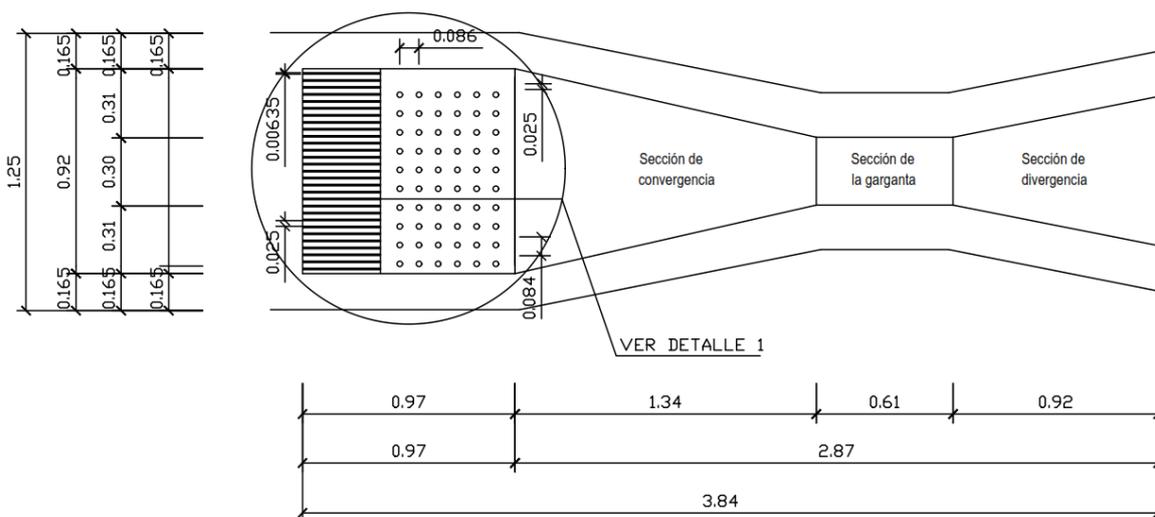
Vista en planta del pozo recolector (aliviadero) de la PTAR.
